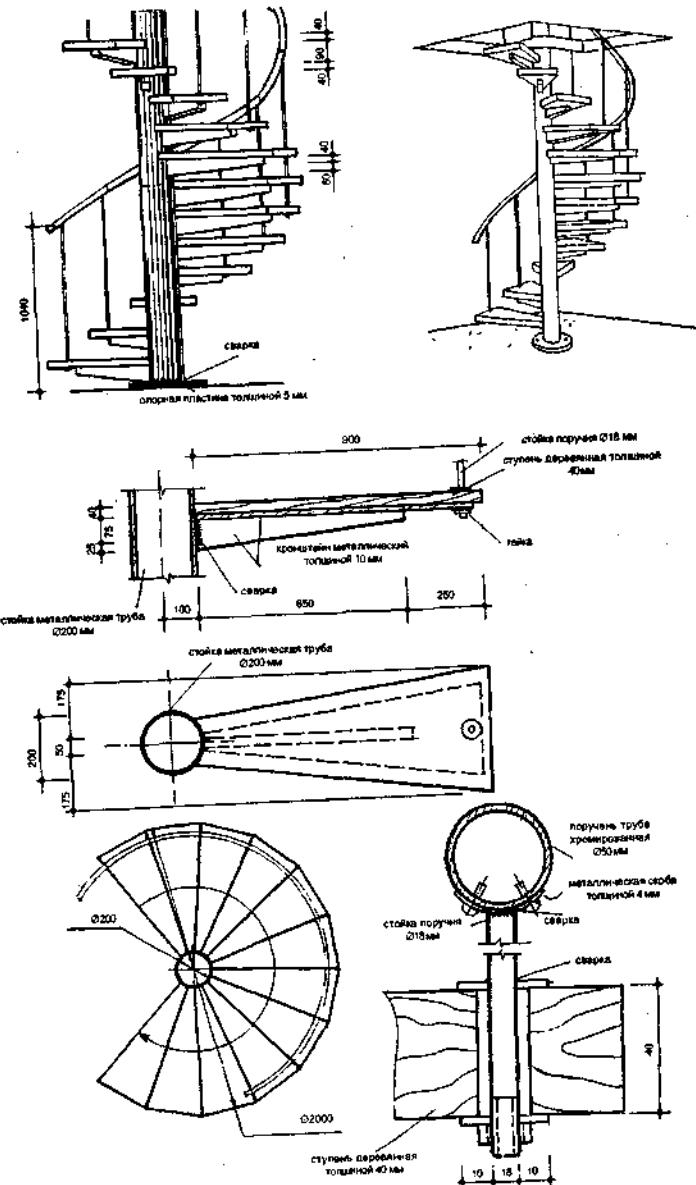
Конструкция винтовой лестницы с металлическим каркасом (дизайн-класс РААИ)
